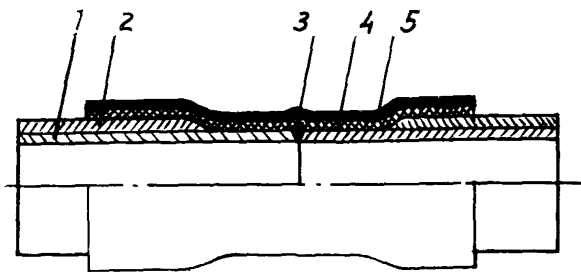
Изоляция сварного стыка липкими полимерными лентами:
